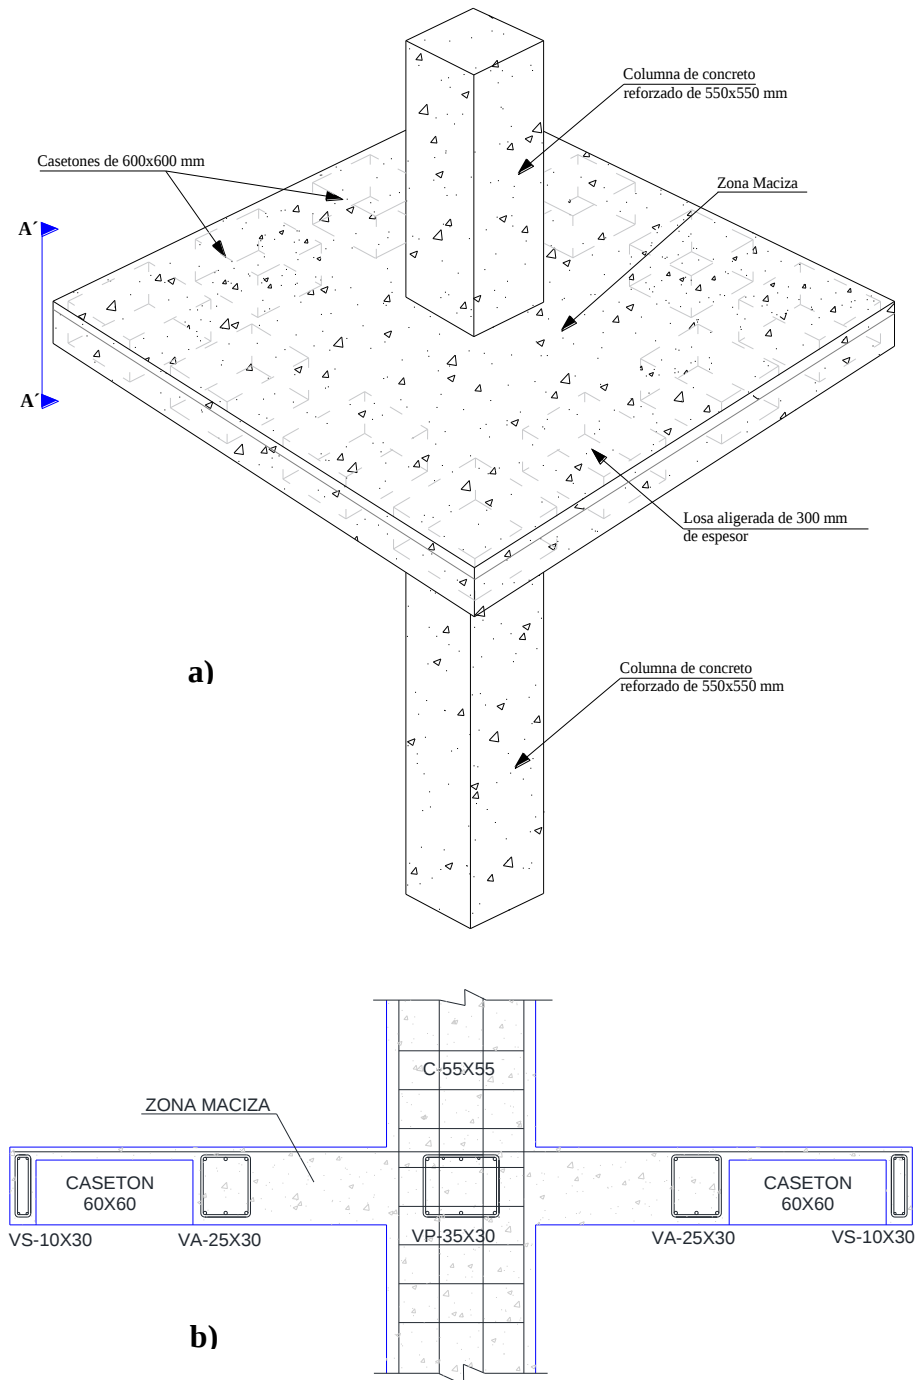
Espécimen de concreto reforzado (MCR-1); a) vista tridimensional y b) vista en corte A'-A'.
